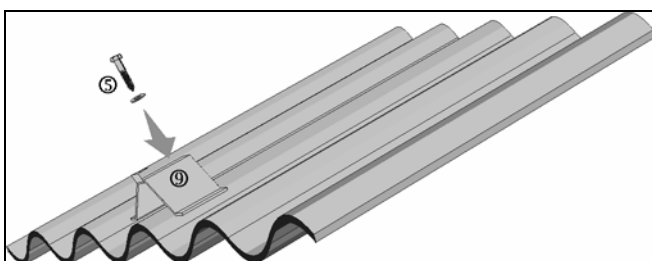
Auf Dächern mit Wellplatten Sparrenanker auf den Wellenberg setzen und durch den Belag mit dem Sparren verschrauben. Die Bohrung in der Welldachplatte muss vor Eindringen von Feuchtigkeit abgedichtet werden.
